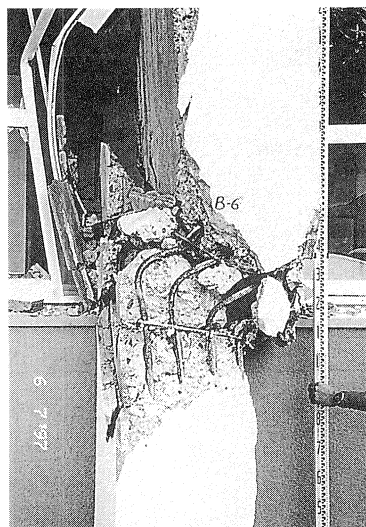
宮之城高校の鉄筋コンクリート柱の破壊
